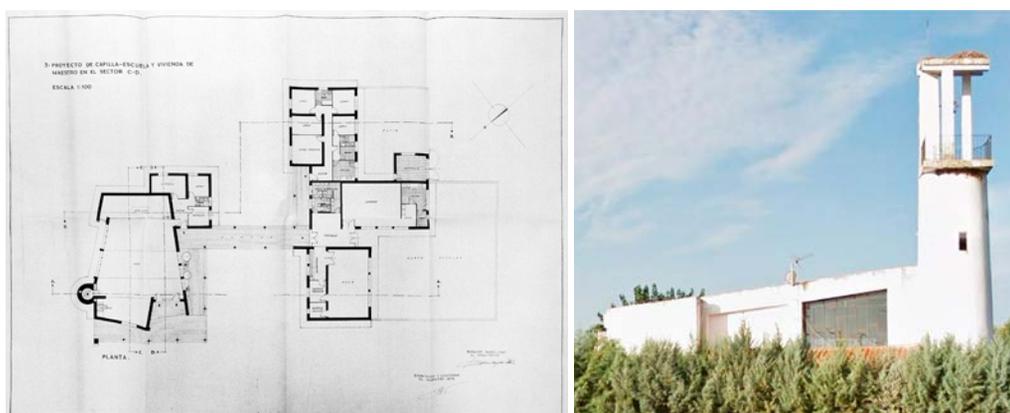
Plano de planta y exterior de la Capilla-Escuela de Barbaño.
